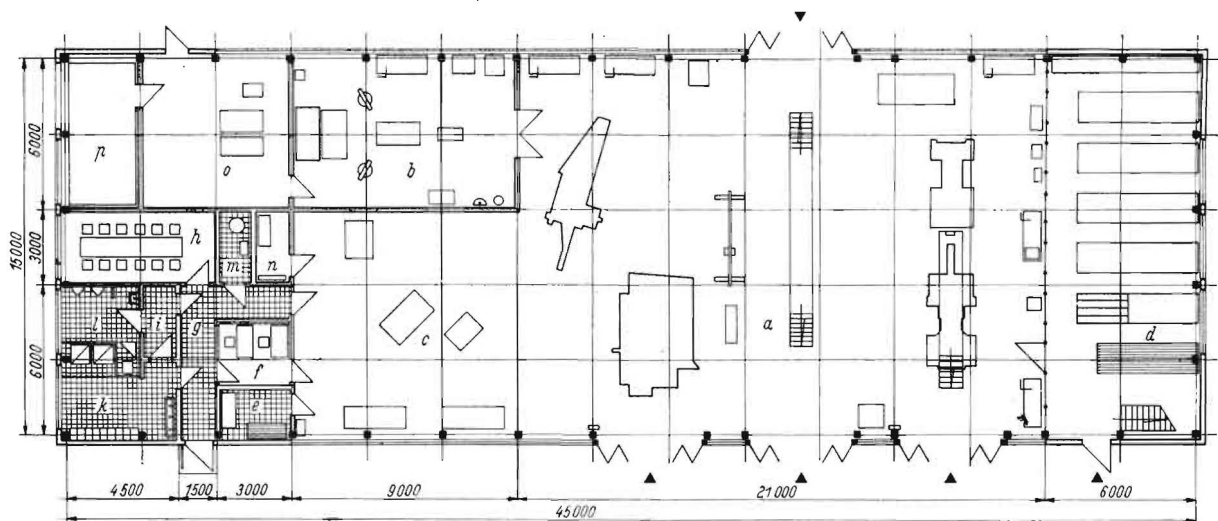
Betriebswerkstatt für Landwirtschaftsbetriebe mit etwa 35 Traktoren; Grundrißkonzeption nach dem Betriebswerkstatt-Baukasten des WTZ Schlieben. a Instandsetzungshalle, b Schmiede, c Stellmacherei, d Ersatzteillager, e Akku-Laderraum, f Meister-
